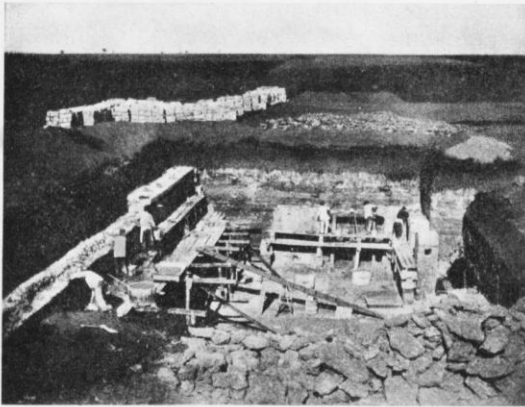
Подвалъ Станции. Въ общемъ котлованѣ, глубиной до 3 саж., вырытомъ въ каменистомъ известковомъ грунтѣ, идутъ каменные работы по возведенію столбовъ, на которыхъ будутъ выложены наружная стѣны подвала. Въ центрѣ снимка видна работа арки изъ кирпича на цементномъ растворѣ, перекрывающей правый пролетъ между угловымъ и среднимъ столбами. Слева, на продольной стѣнѣ, по аркамъ между столбами, уже выведена сплошная стѣна изъ дикарнаго камня до паза для желѣзо-бетоннаго перекрытія. На переднемъ планѣ снимка — кучи «дикаря», извлеченнаго изъ выемки; за котлованомъ штабели штучнаго камня — «пятерика» изъ одесскихъ городскихъ каменоломенъ, а вправо и вдалѣ отъ штабелей — виноградникъ Станции.
